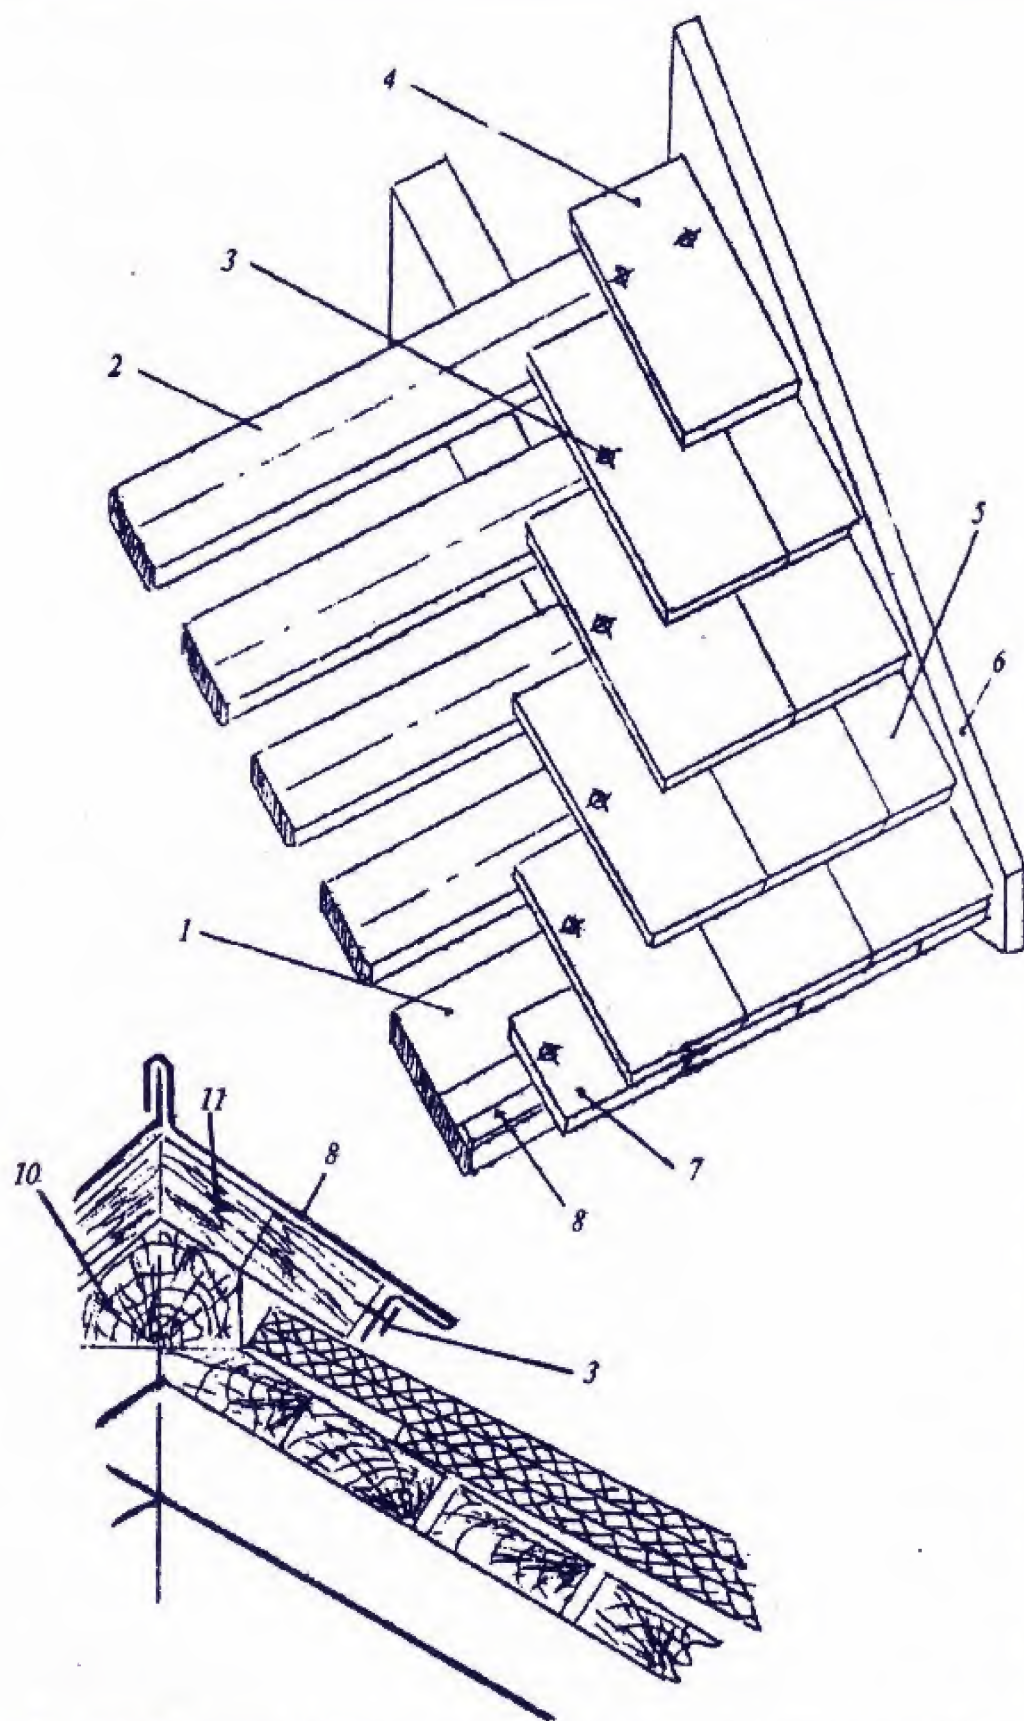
Покриття сланцевими пластинками: 1 – карнизний настил; 2 – решетування з дощок; 3 – цвях; 4 – ціла пластинка; 5 – половина пластинки; 6 – вітрова дошка; 7 – укорочена плитка; 8 – зрівнювальна планка; 9 – покриття з покрівельної сталі; 10 – коньковий брус; 11 – дошка.
